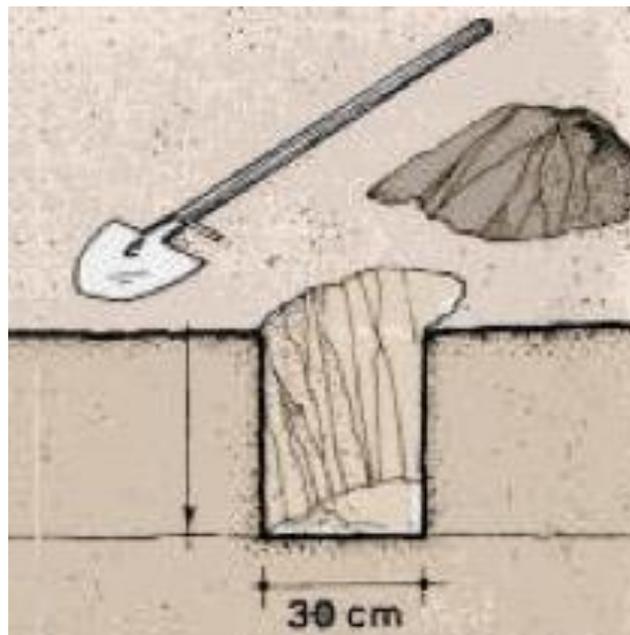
Excavación de hoyo con 30 cm de diámetro.
